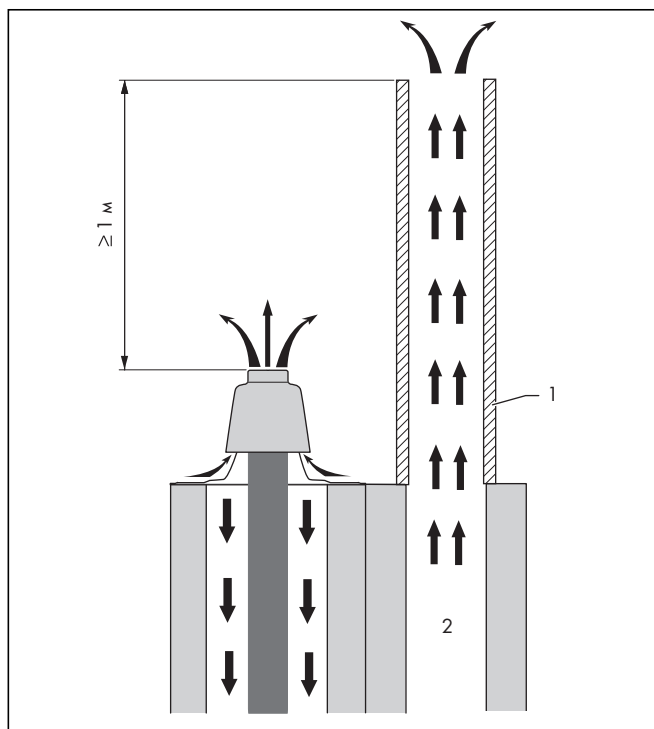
Высота дымовой трубы над отводом ОГ из ПП - с забором воздуха не из помещения
